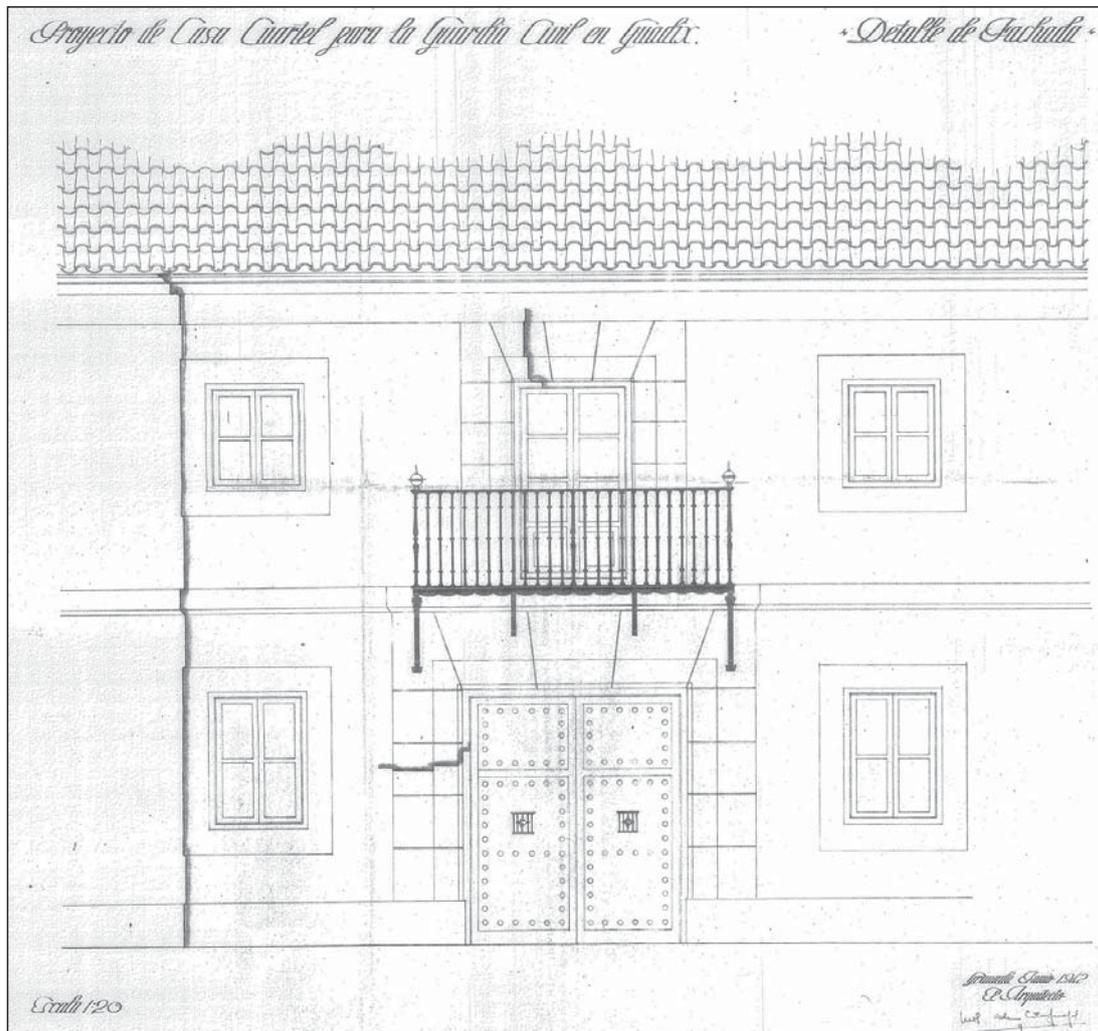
Detalle de fachada del Cuartel de la Guardia Civil.
